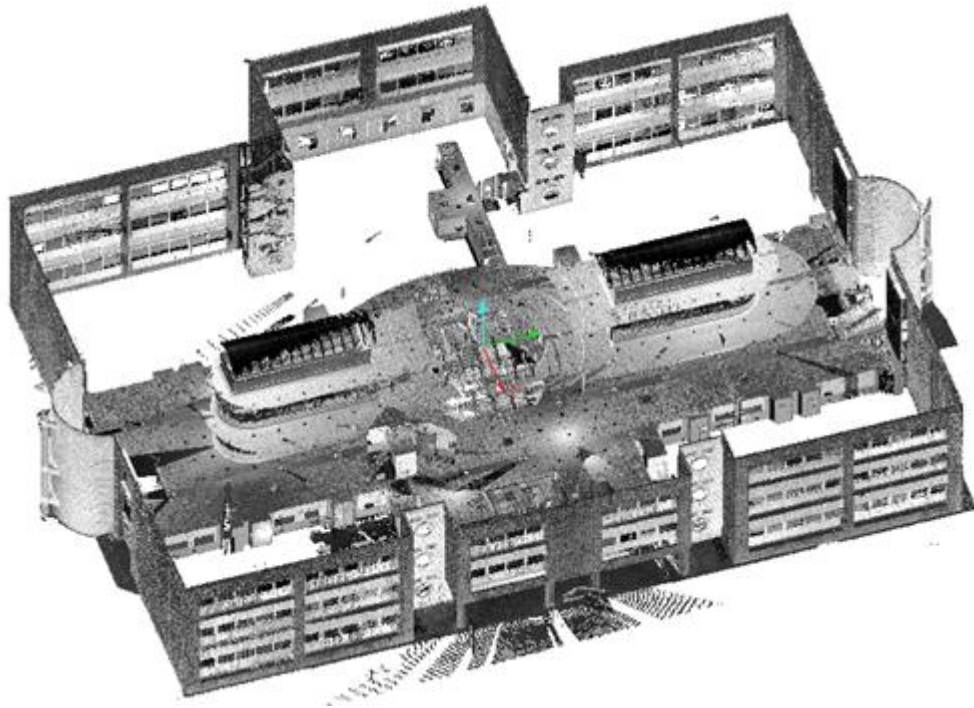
Escaneos orientados en MapTek I-Site (Exterior y planta baja).
